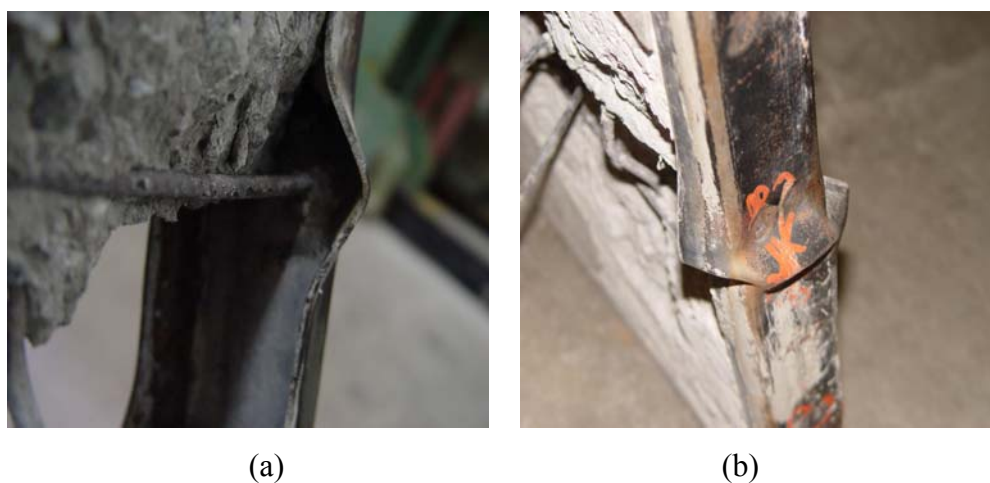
(a) Vista interna e (b) vista externa de esmagamento do perfil de aço
